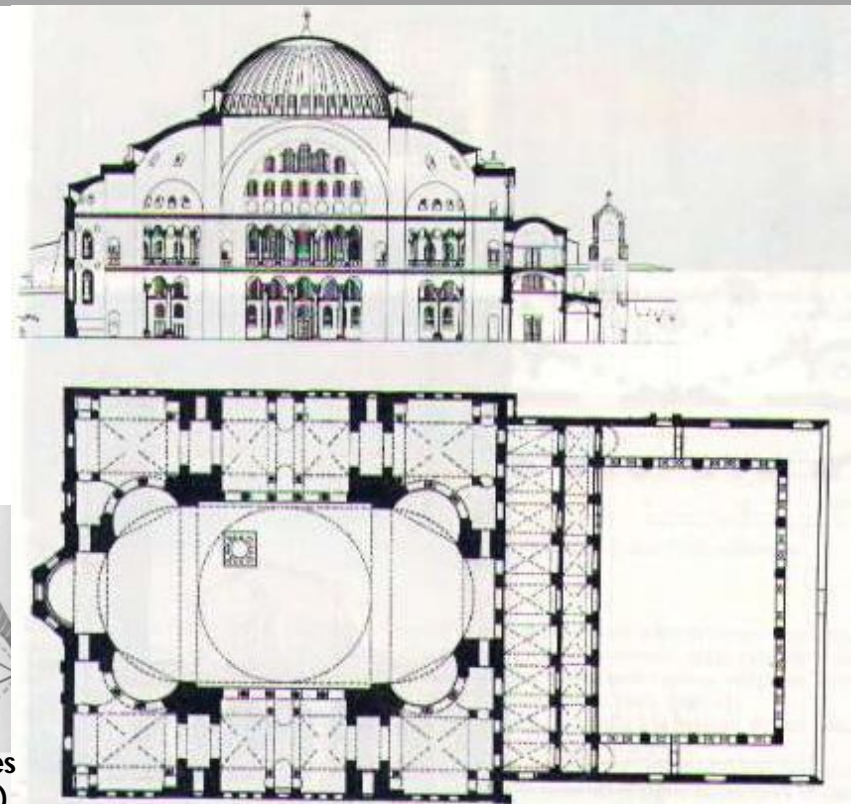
Corte e Planta da Igreja de Santa Sofia.
